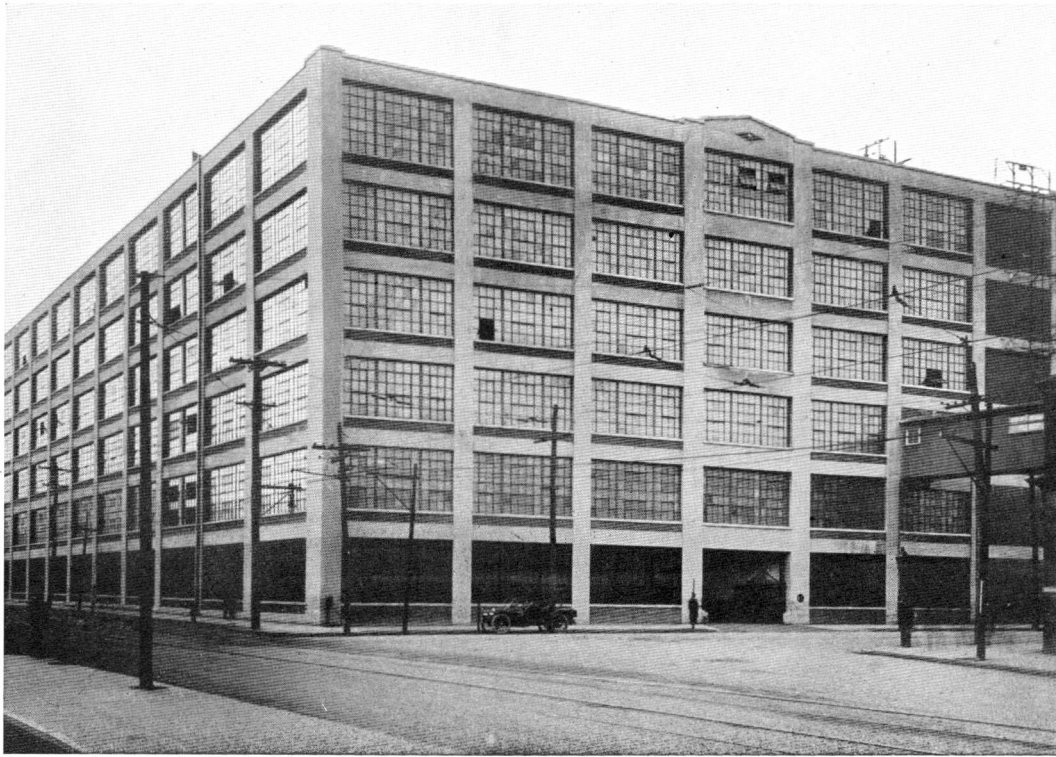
Fabrikgebäude der Winchester Gewehrfabrik New Haven, Conn.
